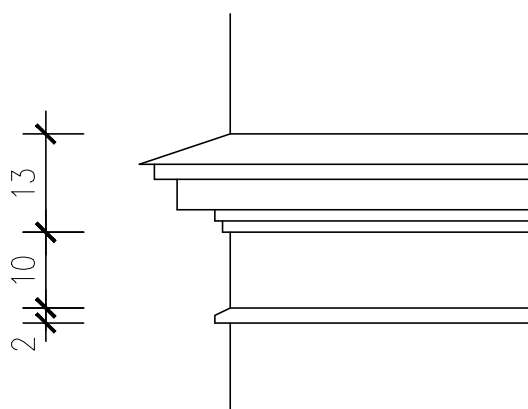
DETAIL PROFILACE ŘÍMSY - 2, horní, délky 38m
